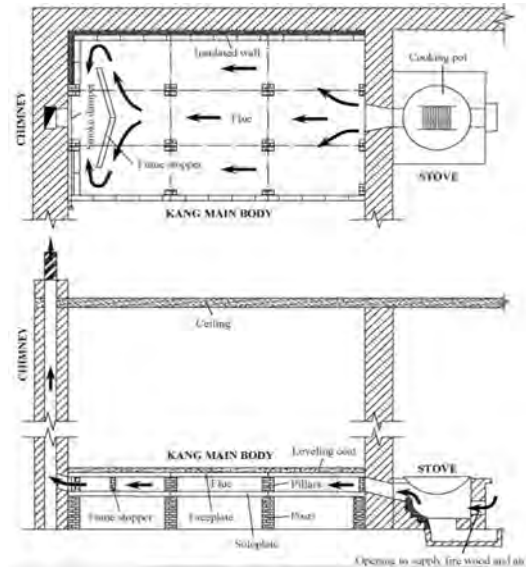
Grundriss und Schnitt vom Kang-System
